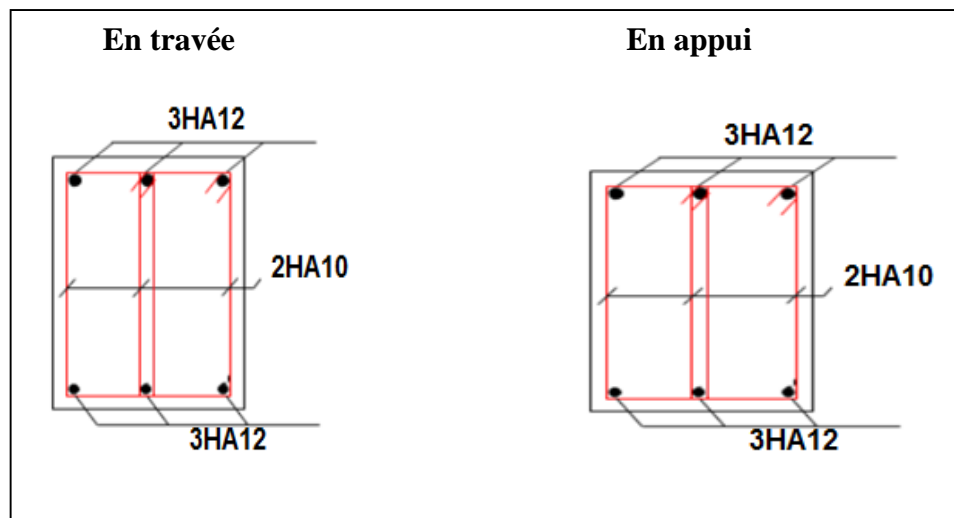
Schéma de ferrailage des poutres de redressement
